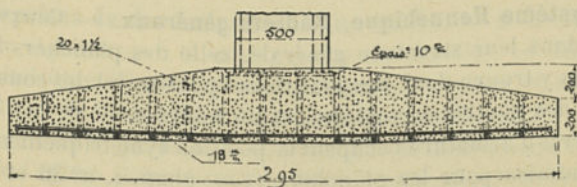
Filature de MM. Barrois à Lille. Fondation d'un pilier.
